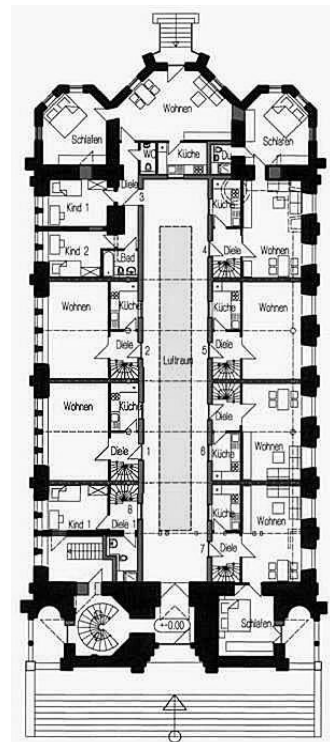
Grundriss Erdgeschoss, Umnutzung als Wohngebäude 1998
